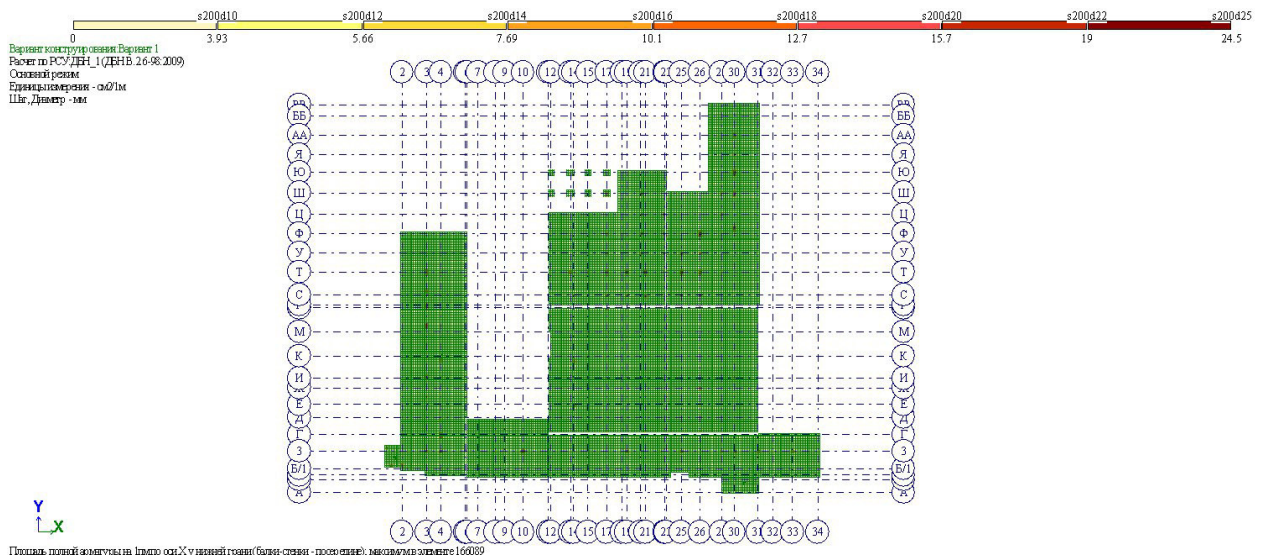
Площадь полной нижней арматуры на 1 м.п. по оси X
